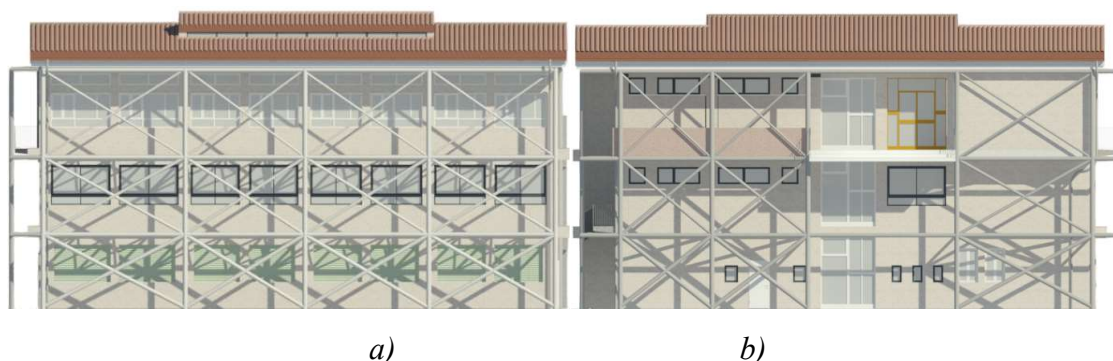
Disposizione in alzato dell'esoscheletro in direzione X: a) Prospetto Sud; b) Prospetto Nord
